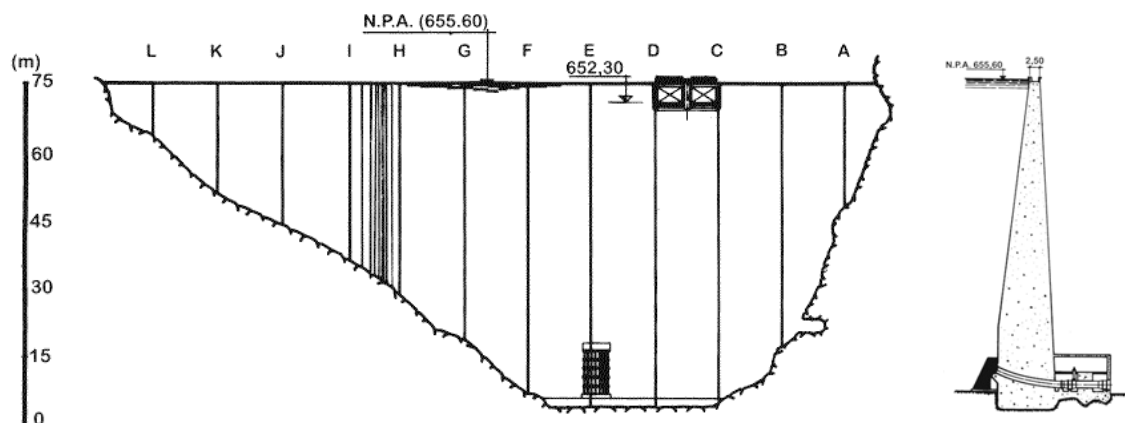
Barragem de Santa Luzia. Alçado de montante e corte pela consola central. (fonte: www.inag.pt)
